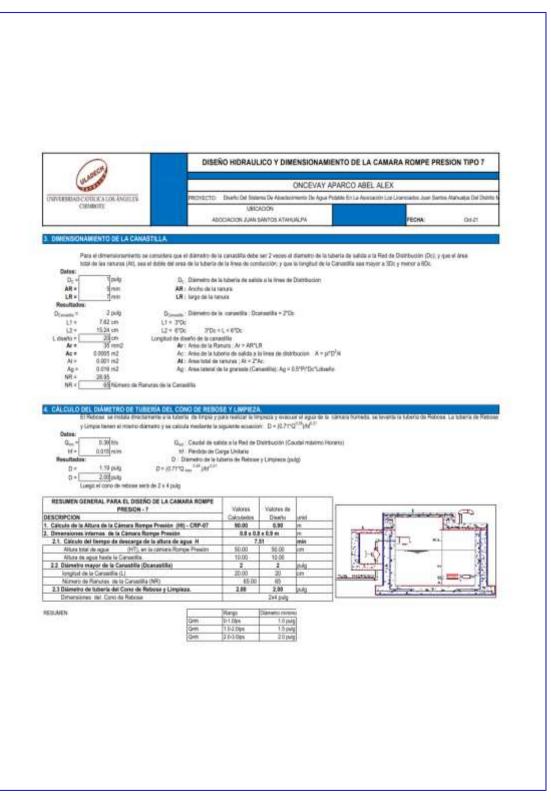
Diseño hidráulico y dimensionamiento de la cámara rompe presión tipo 7 (c)
